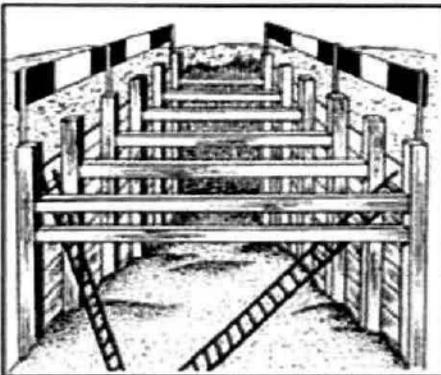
Barreras a ambos lados de una zanja, para impedir que los trabajadores caigan dentro de ella.
